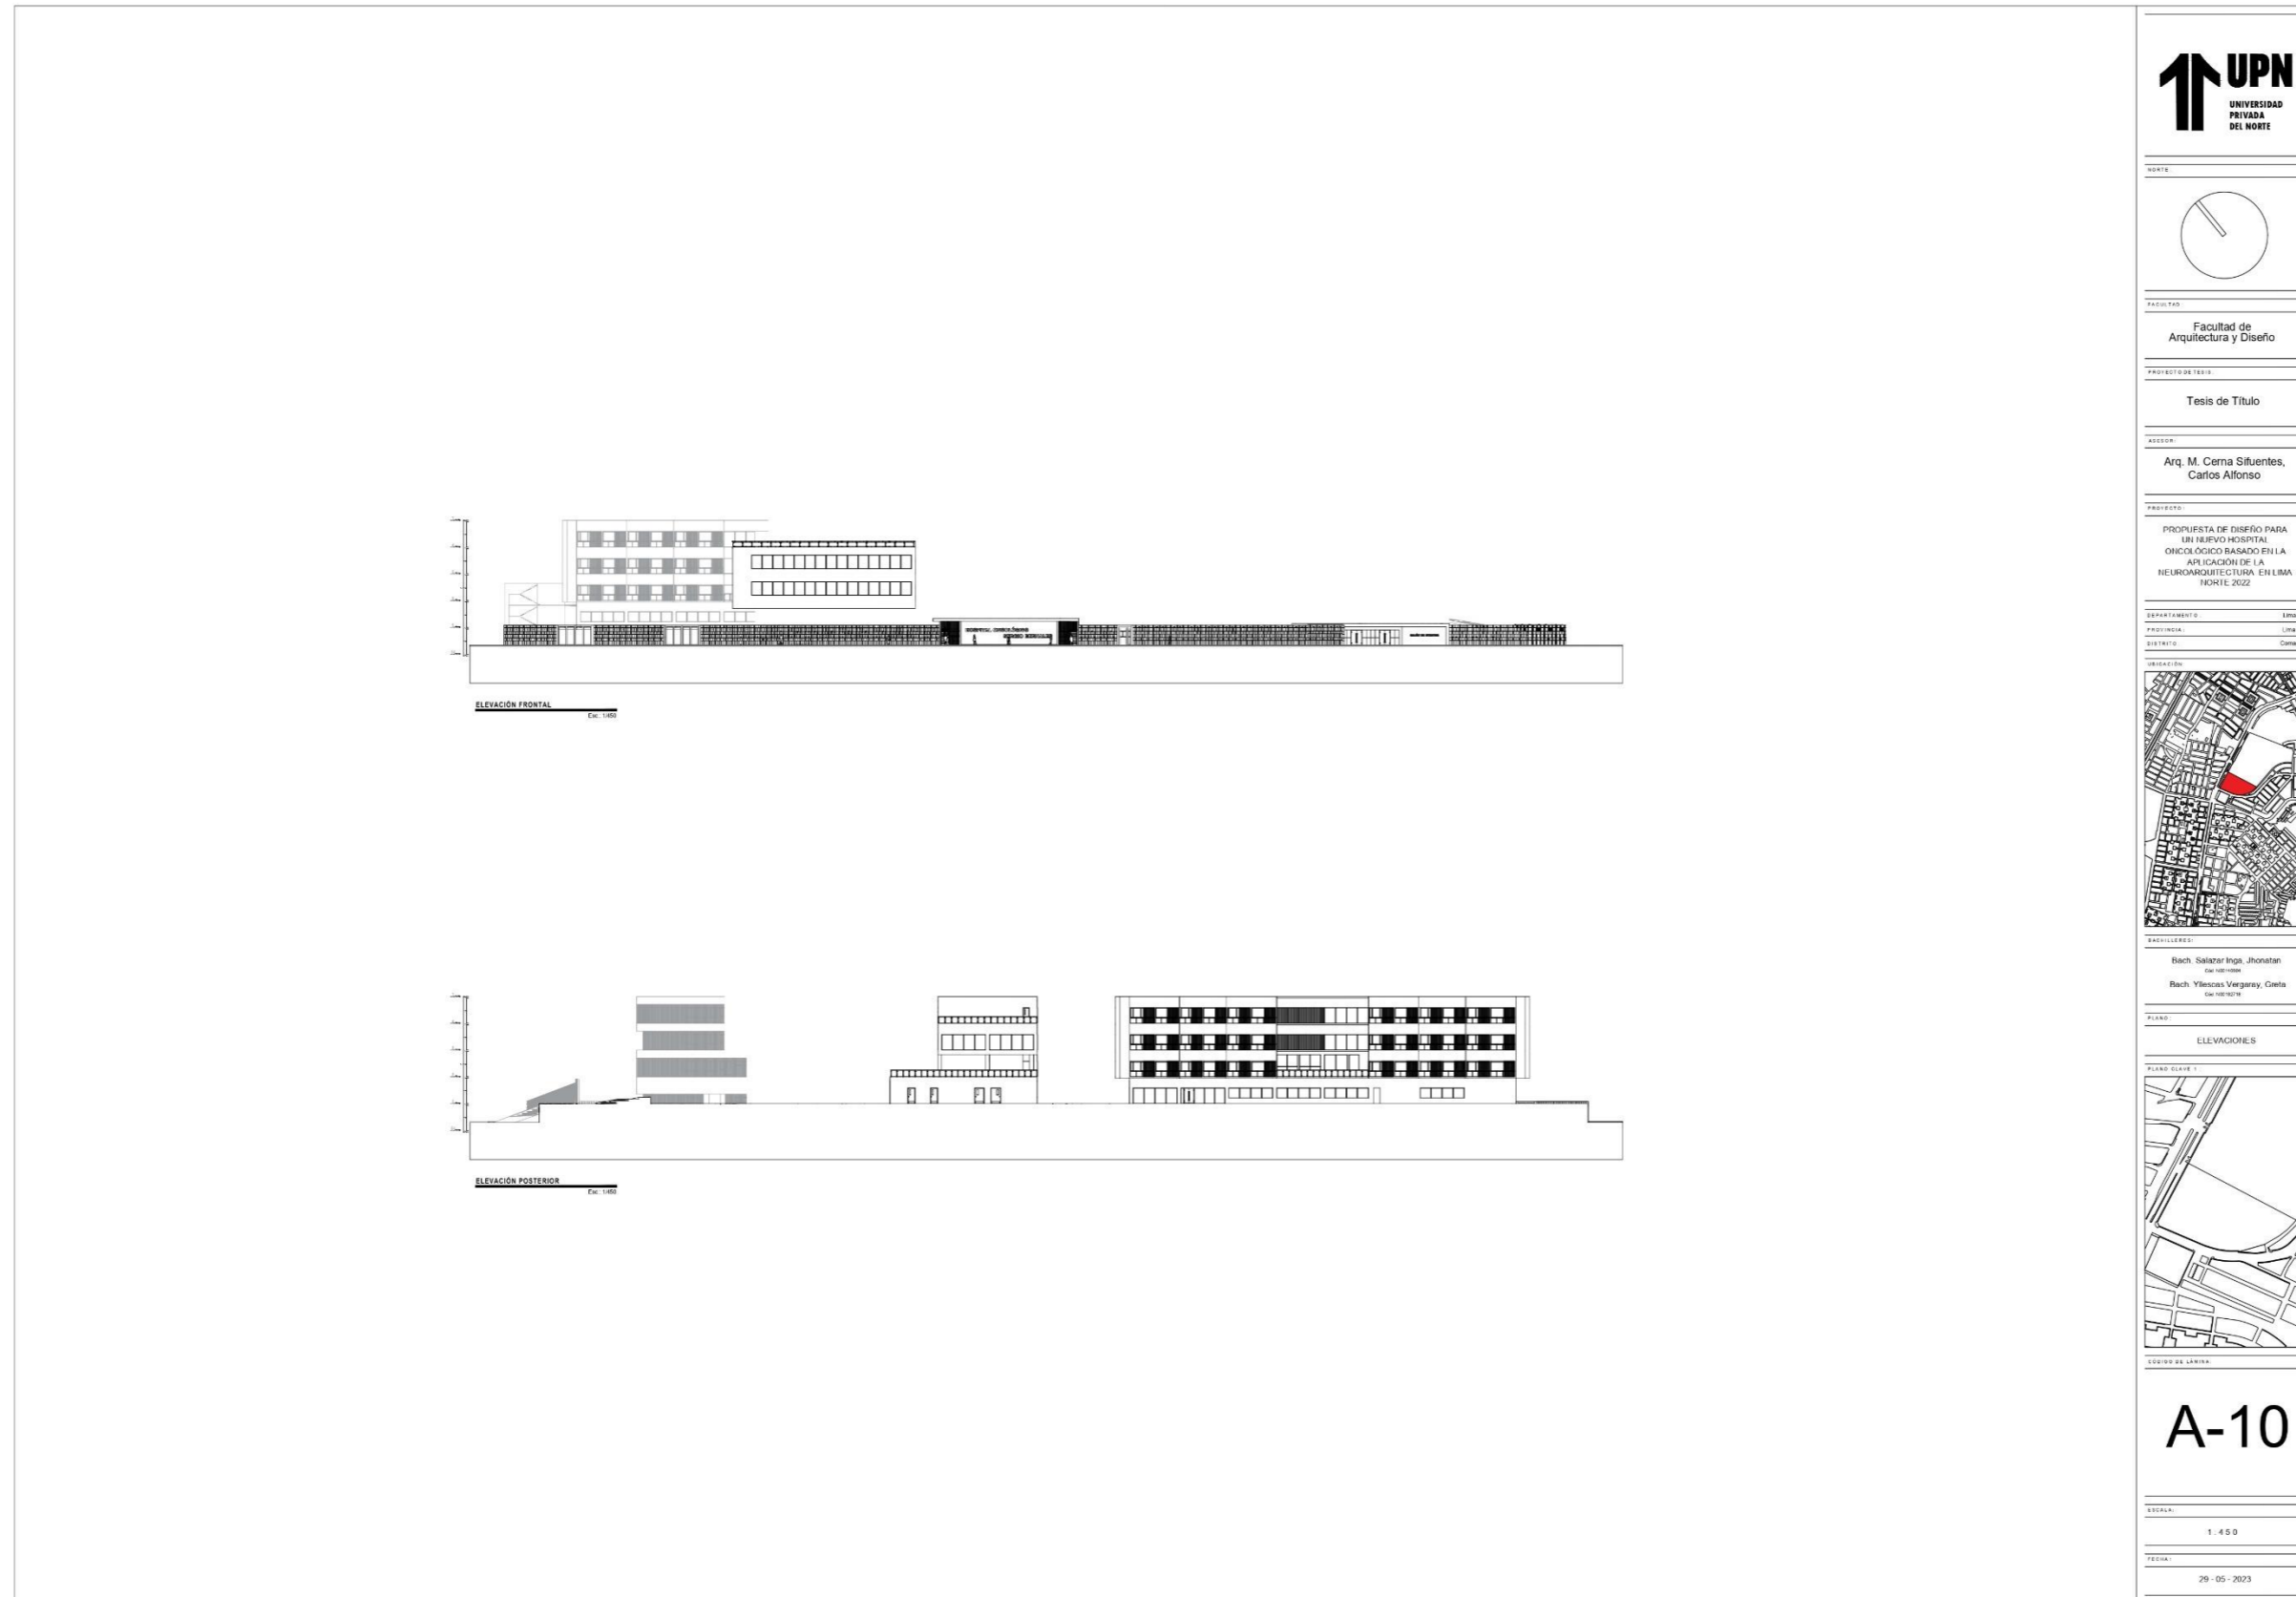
Arquitectura – Elevaciones N°1 Esc: 1/450 (Fuente: Elaboración propia de los coautores)
